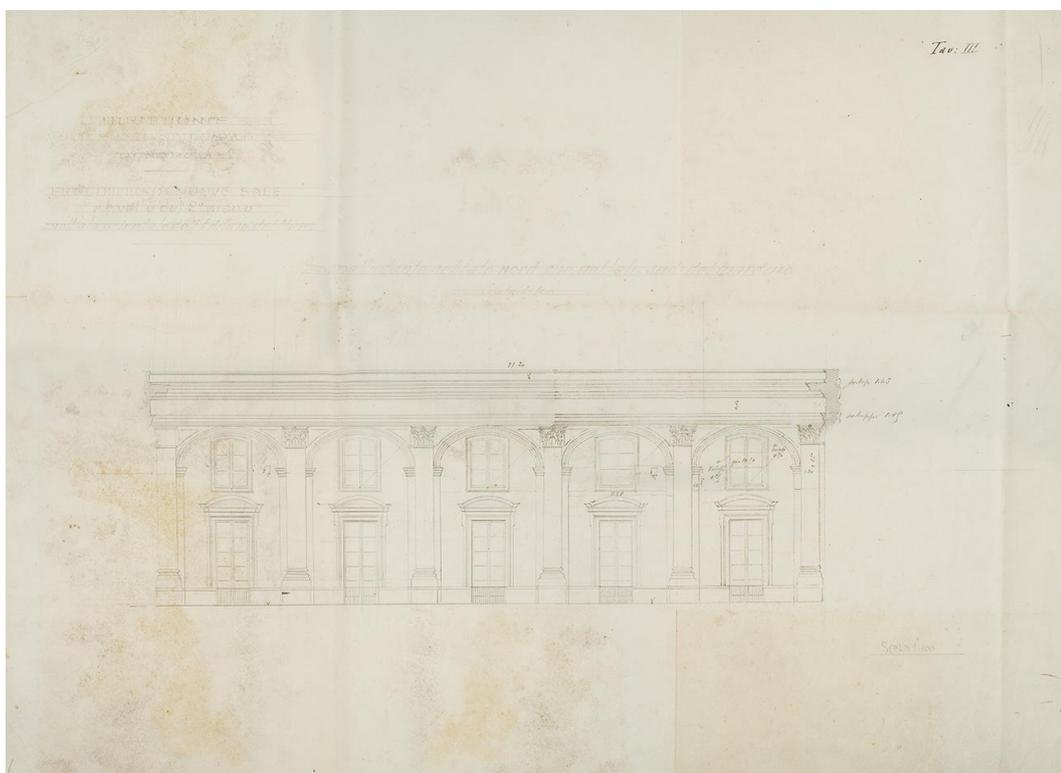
MANN, *Archivio Storico*, XV B1, 9, Museo lavori 2° piano c, Tavola III. Progetto di nuove sale nell'ala orientale dell'edificio del Museo. Prospetto tanto nel lato nord che nel lato sud del giardino, scala 1:100. Su con. MiC ©
